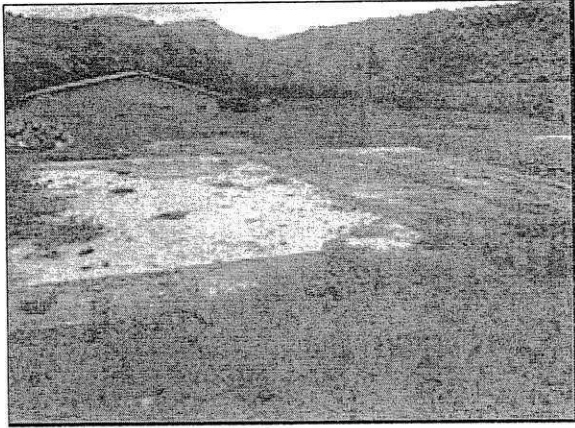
Vista do Terreno onde será construído o Fórum de Pilões
